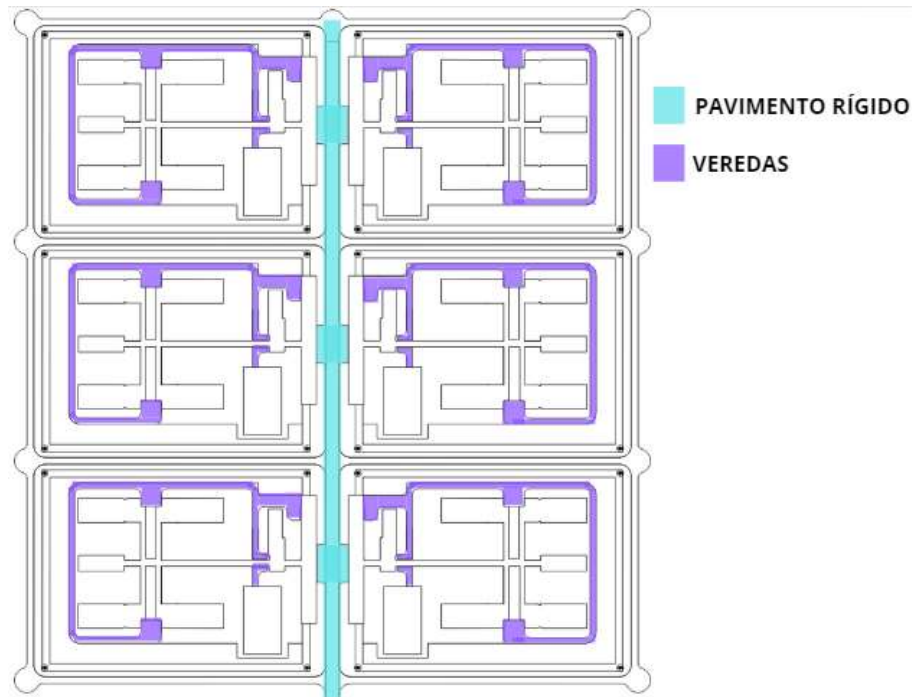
Planta de recorrido de pavimentos y veredas peatonales.
